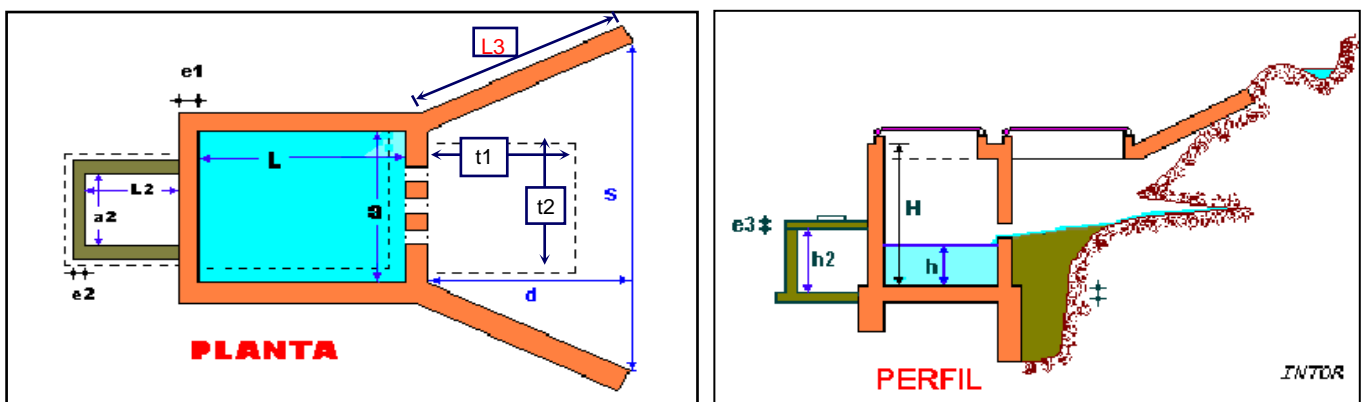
Diseño de Captación en Planta y Perfil.
